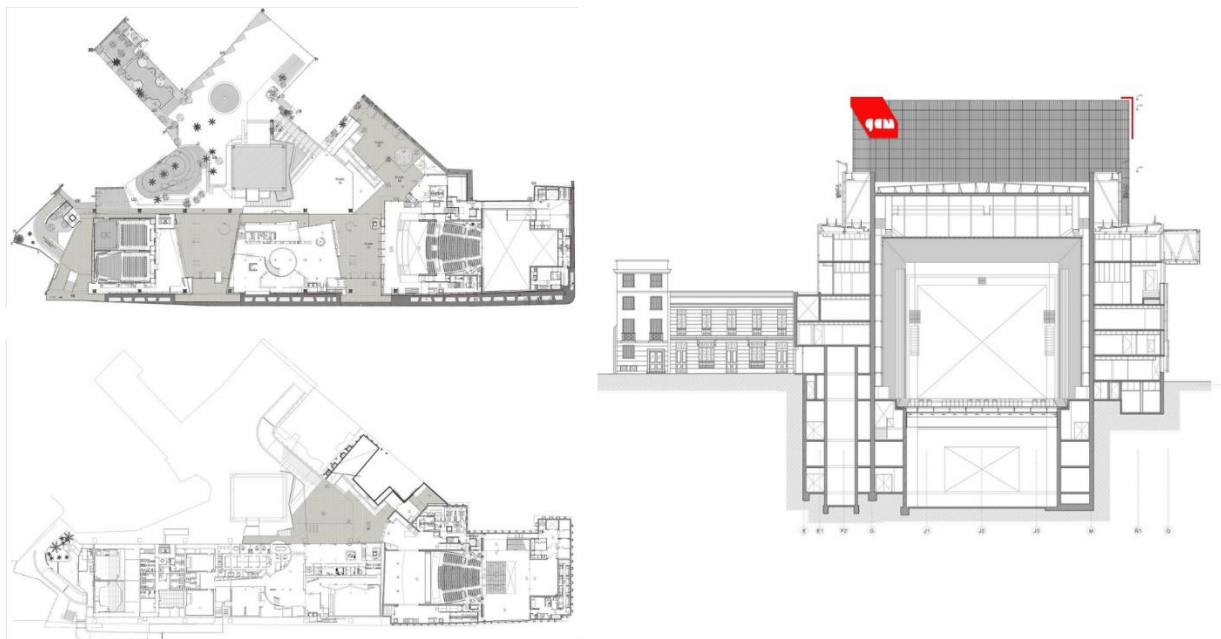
Plantas y corte transversal sector sur, GAM. Fuente: Plataforma Arquitectura, 2015
